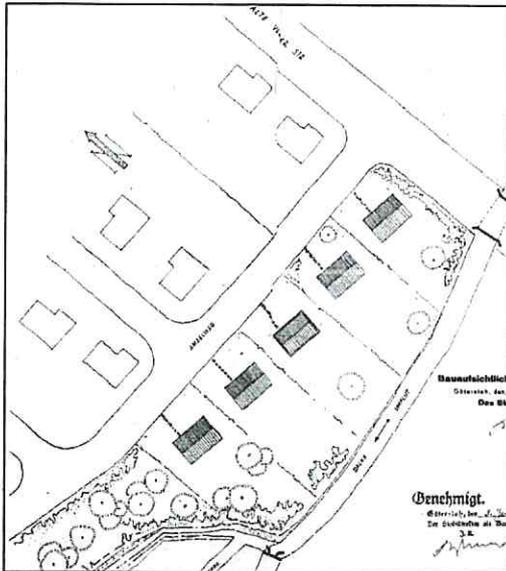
Lageplan der 5 Offiziershäuser Typ IV, gebaut 1953
